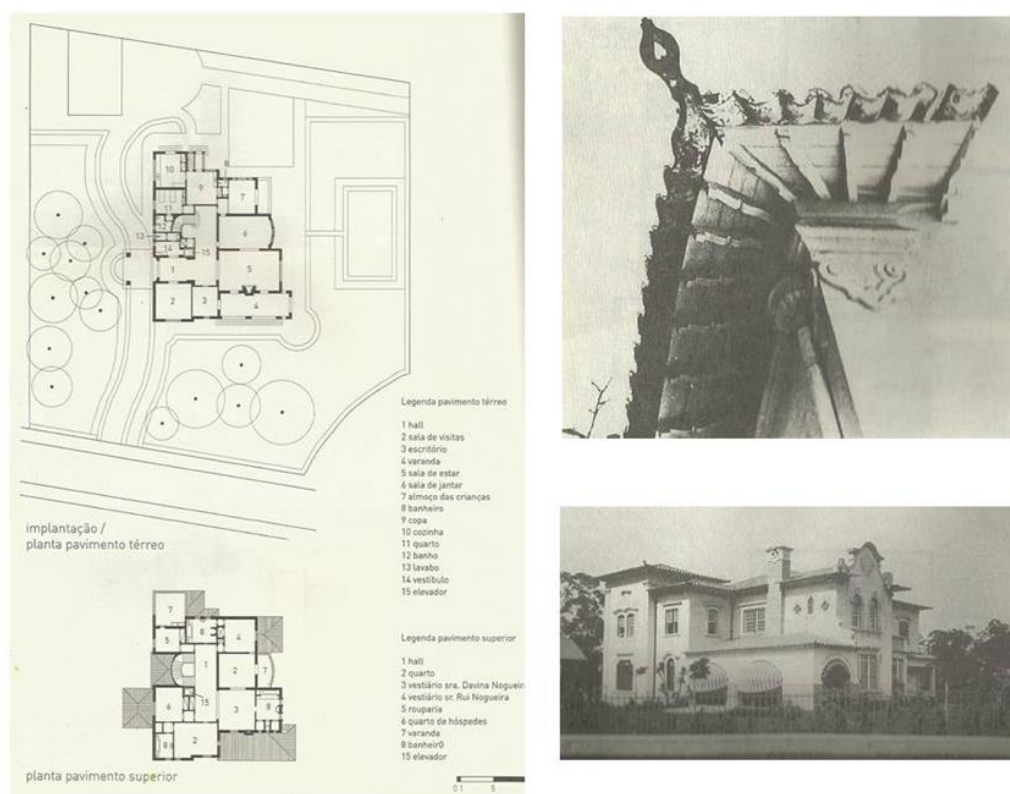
Casa Rui Nogueira (Ricardo Severo, São Paulo, 1939): Planta de Implantação/planta do pavimento térreo e superior; detalhe do beiral com cachorro em madeira e vista. Fonte: Mello, 2007.
